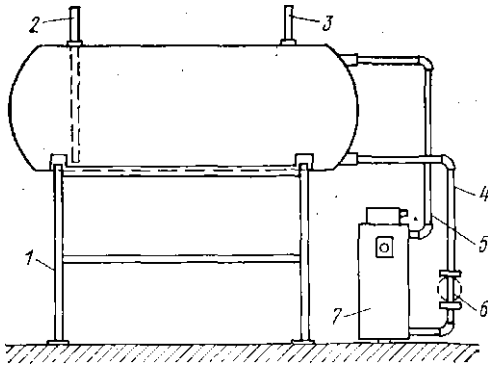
Схема присоединения водомаслонагревателя к обогреваемому резервуару.
